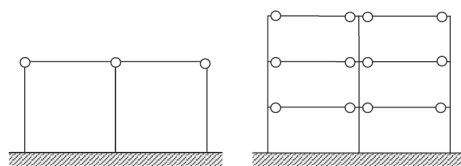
Strutture a telaio con collegamenti a cerniera
